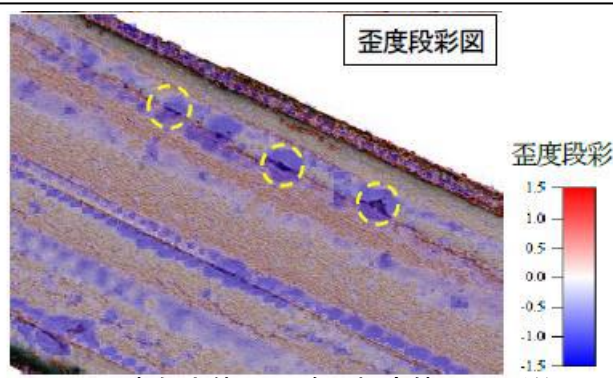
赤色立体図 (路面標高値)と局所的凹型変状の重ね合わせ例
